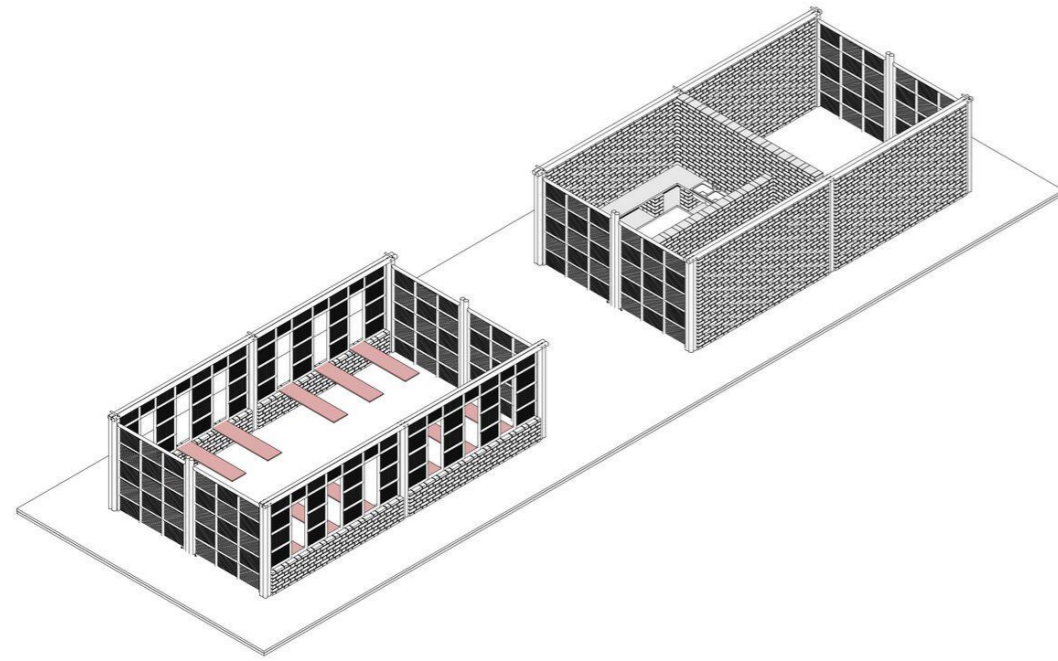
Elevación y planta de distribución del Centro Etno Educativo Walirumana
